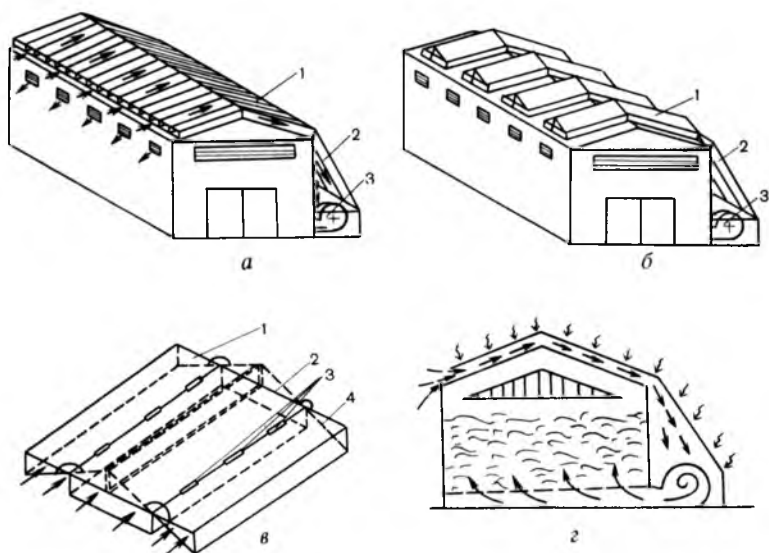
Гелиовоздухонагреватель сушилки конструкции НИПТИМЭСХ НЗ РСФСР:
